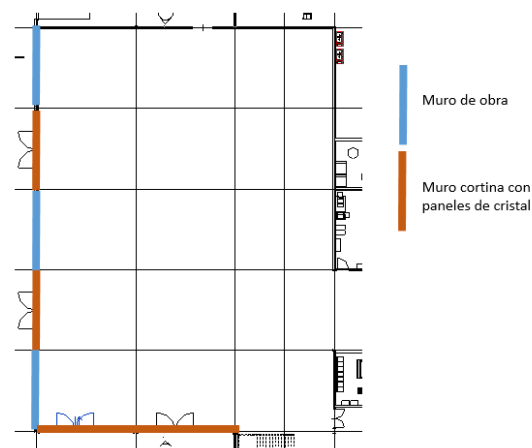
Propuesta muros exteriores en zona Exposición.
